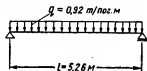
Расчетная схема балки и схема нагрузки.
